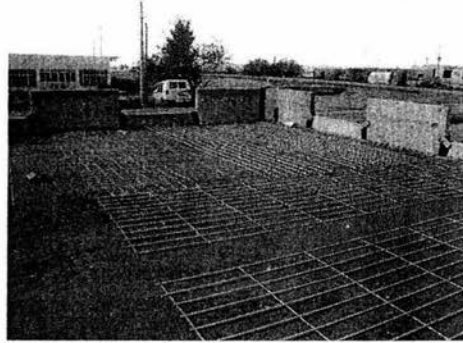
Colocación de mallas para los terraplenes armados en el muro 2
